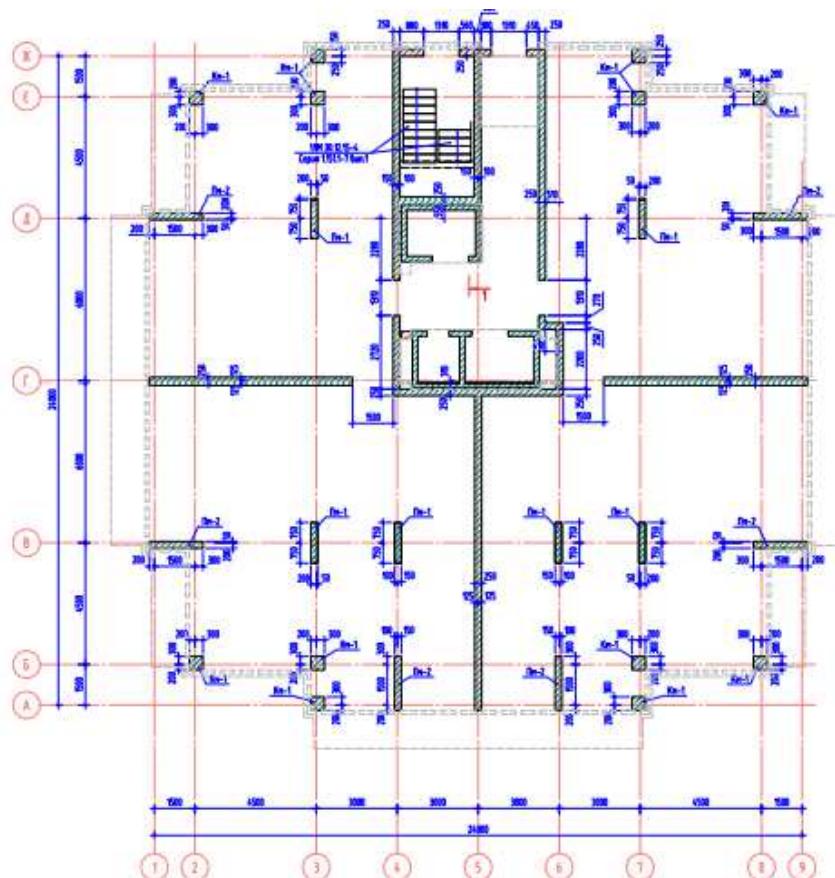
Рассматриваемая плита перекрытия типового этажа
